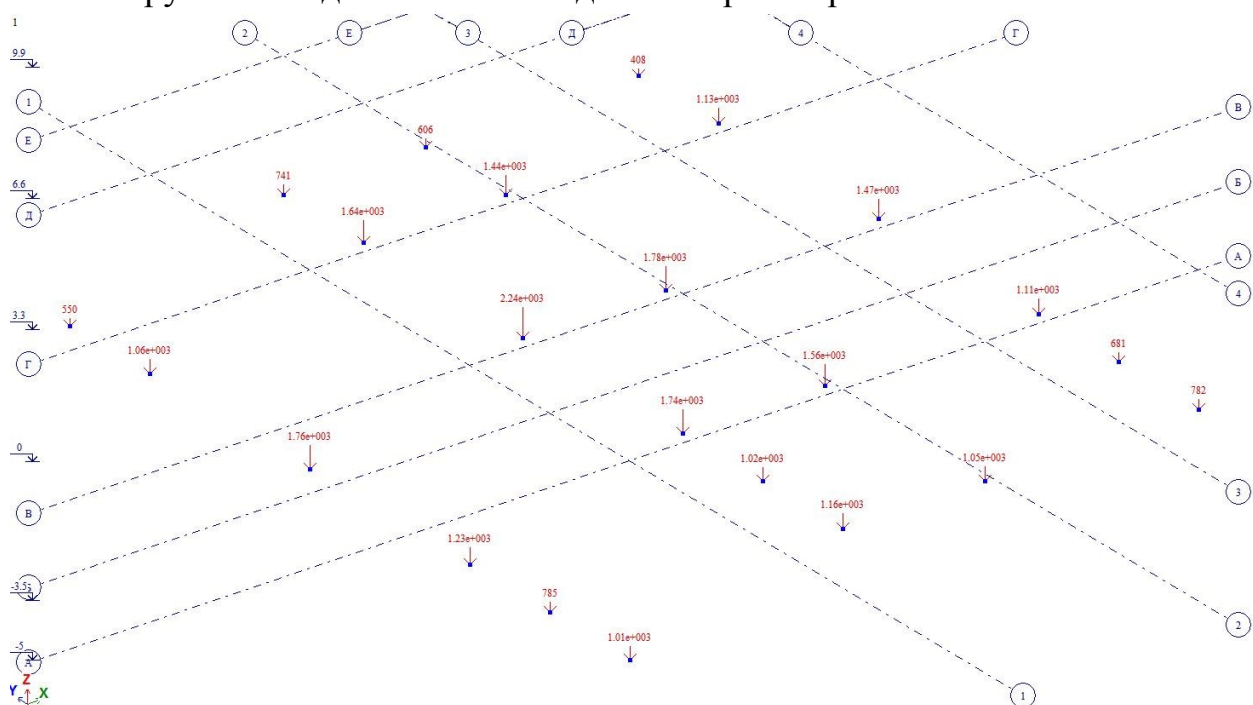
Нагрузка от надземной части здания на ростверк
